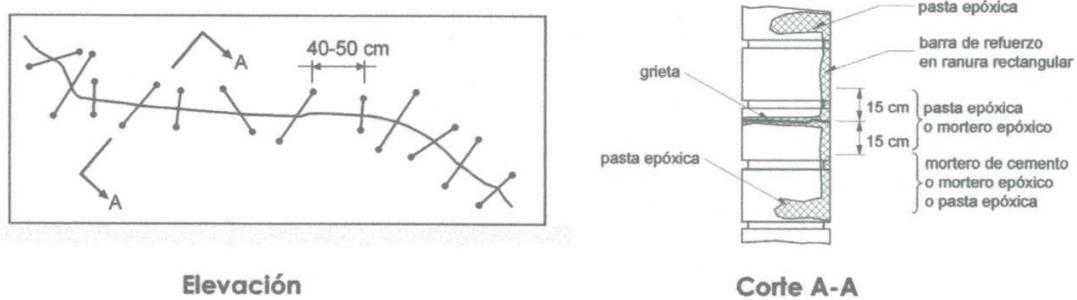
Colocación de grapas sobre grietas en muros de mampostería.
